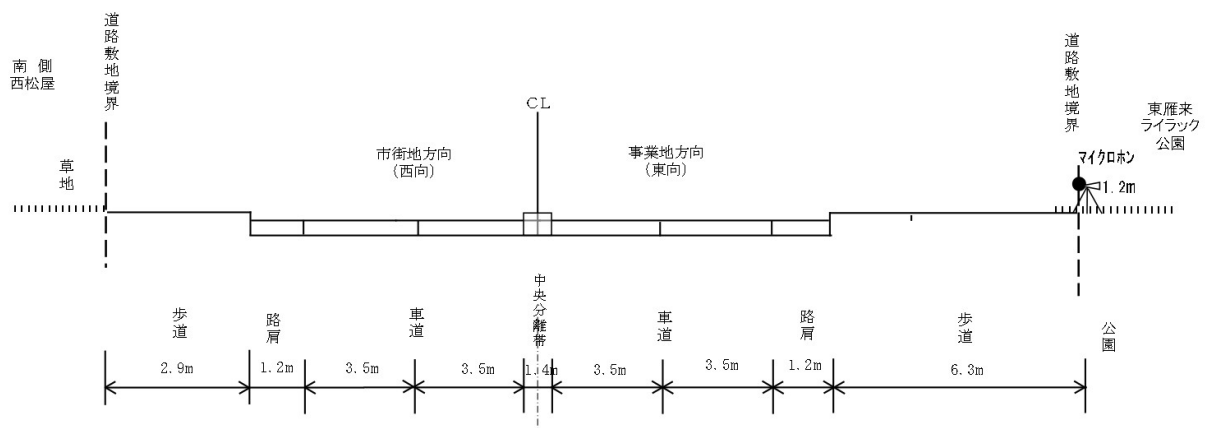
(1) 道路断面図 (K-1 地点 国道 275 号)
